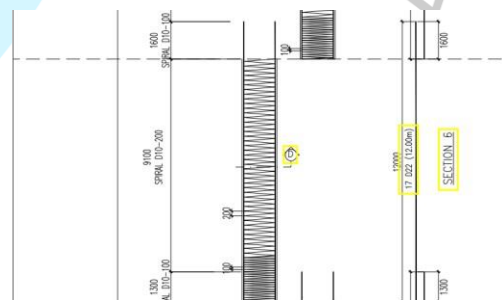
42 Shop drawing detail tulangan bored pile type G section 5
